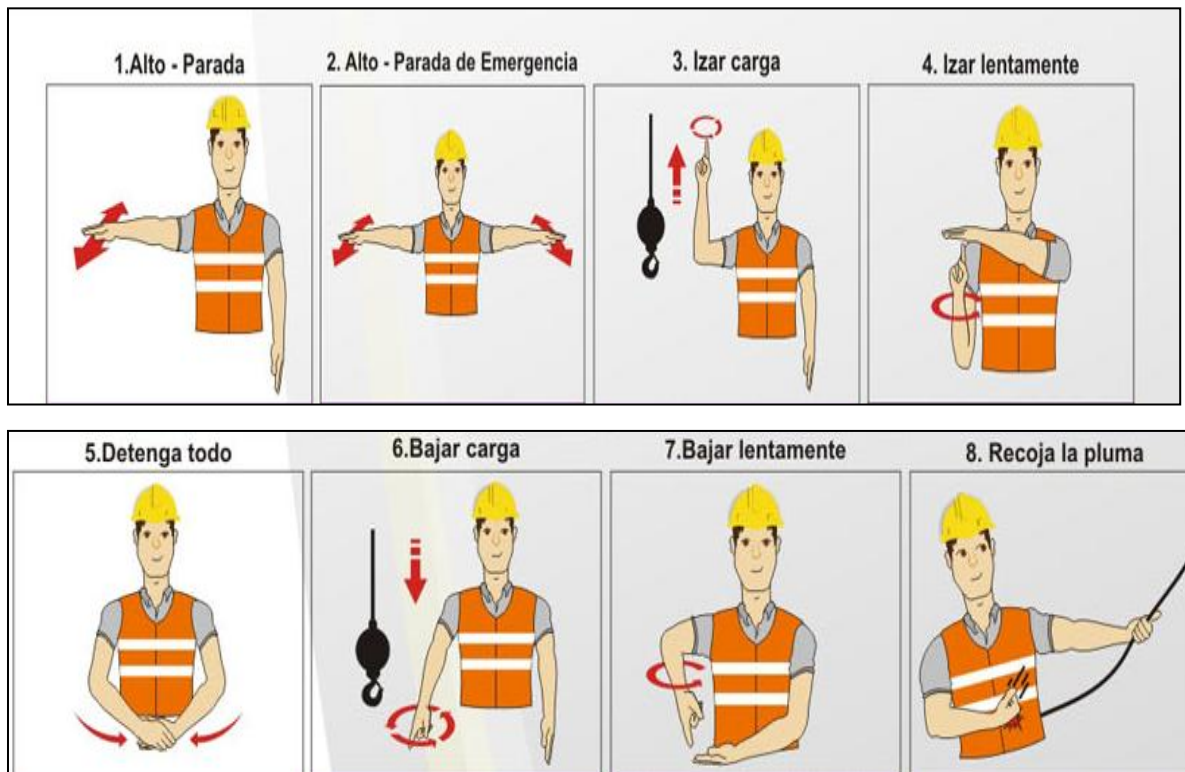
Señales usadas en el montaje de las estructuras metálicas
